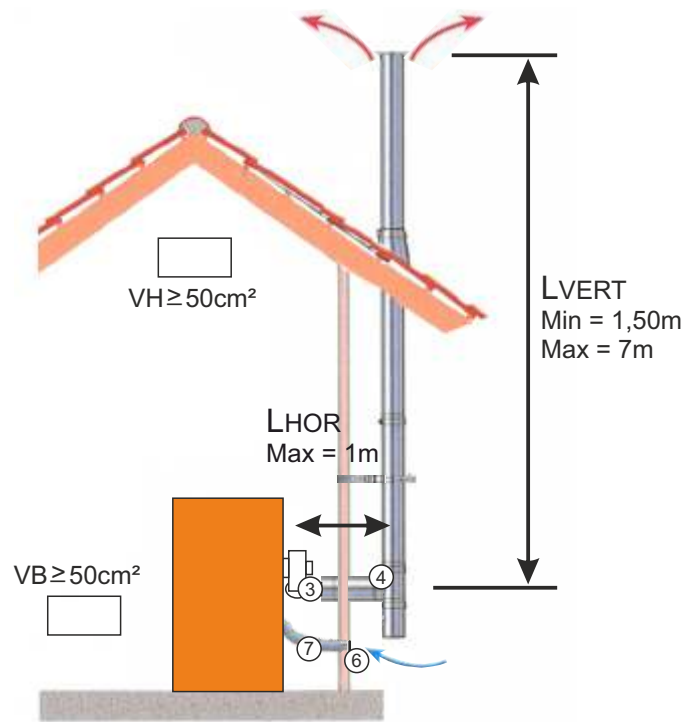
Air frais de la façade - grille murale, cheminée à l'extérieur de la chaufferie
